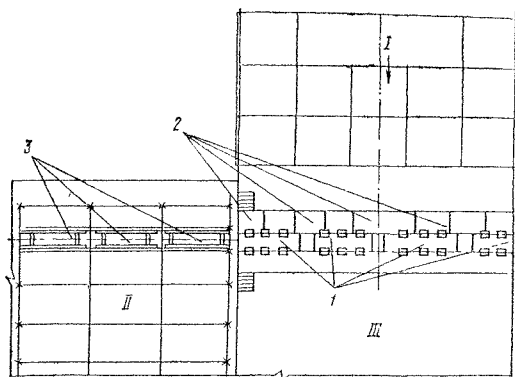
Схема организации работ при монтаже воздуховодов на конвейере подъемным рольгангом
